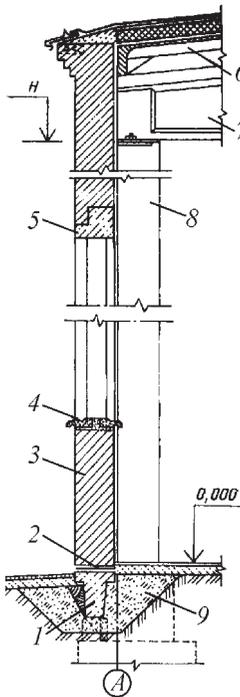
Элементы кирпичных стен: 1 – фундаментная балка; 2 – гидроизоляция; 3 – стена; 4 – подоконная доска; 5 – перемычка; 6 – плита покрытия; 7 – балка покрытия; 8 – колонна; 9 – подсыпка под балку
